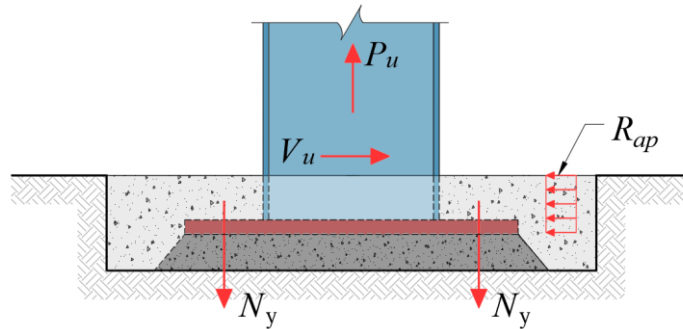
Transferencia de la fuerza cortante por aplastamiento en placa base y la columna metálica
